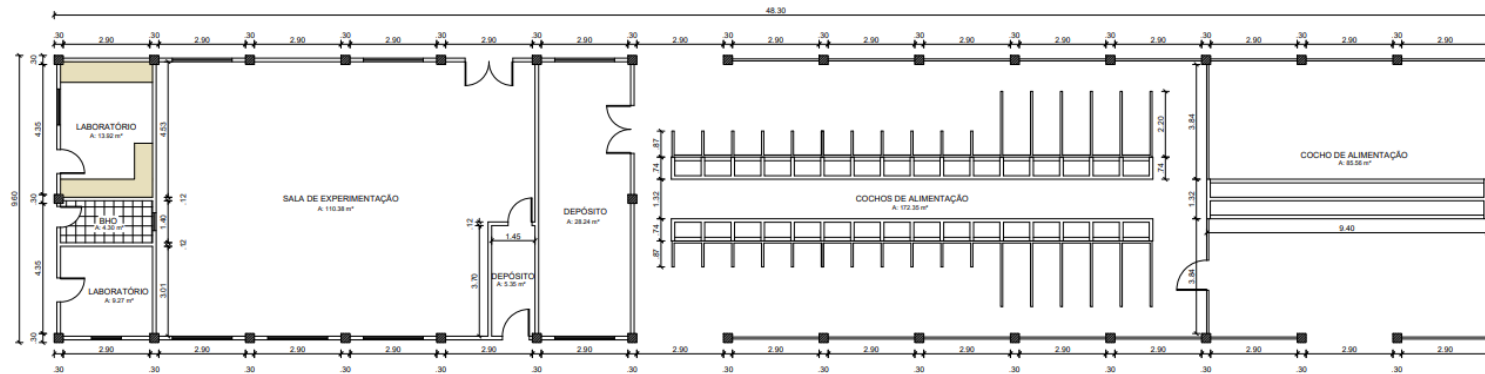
Proposição de layout para o Laboratório de Nutrição Animal
